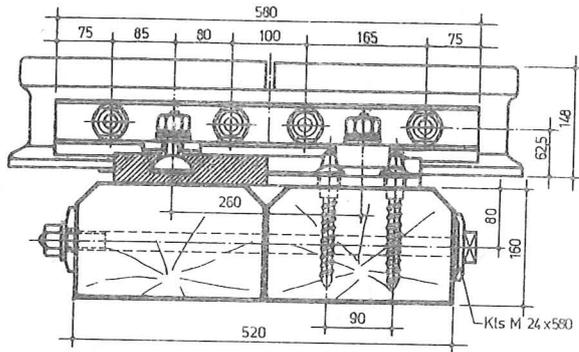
Schienenstoß mit Befestigung nach Oberbau K auf Holzschwellen
